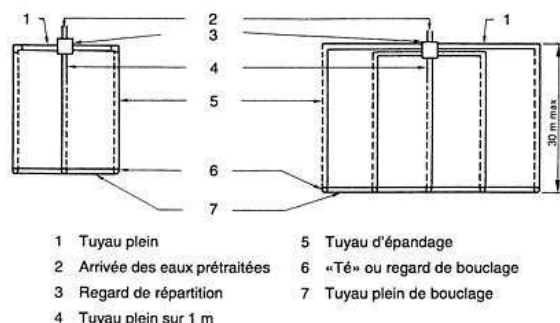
Vues en plan ; exemples à 3 et 5 tranchées
